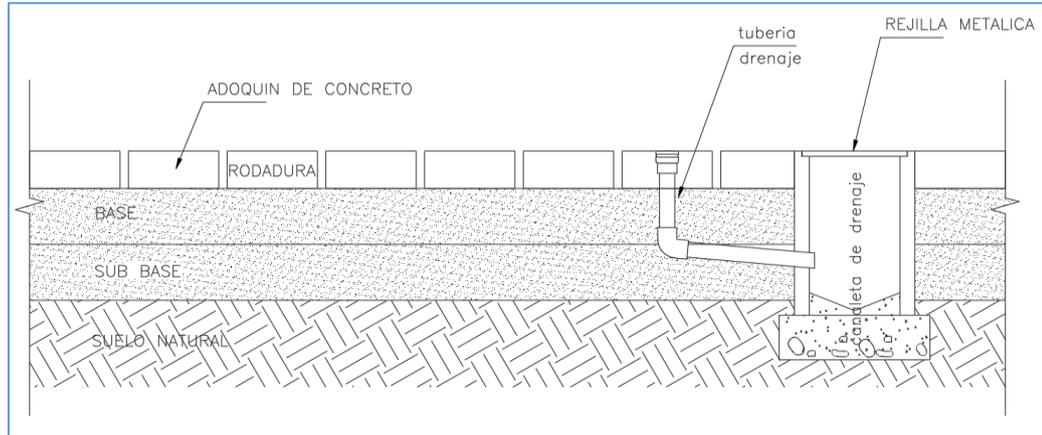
ADOQUINADO Y DRENAJE DEL PROYECTO
